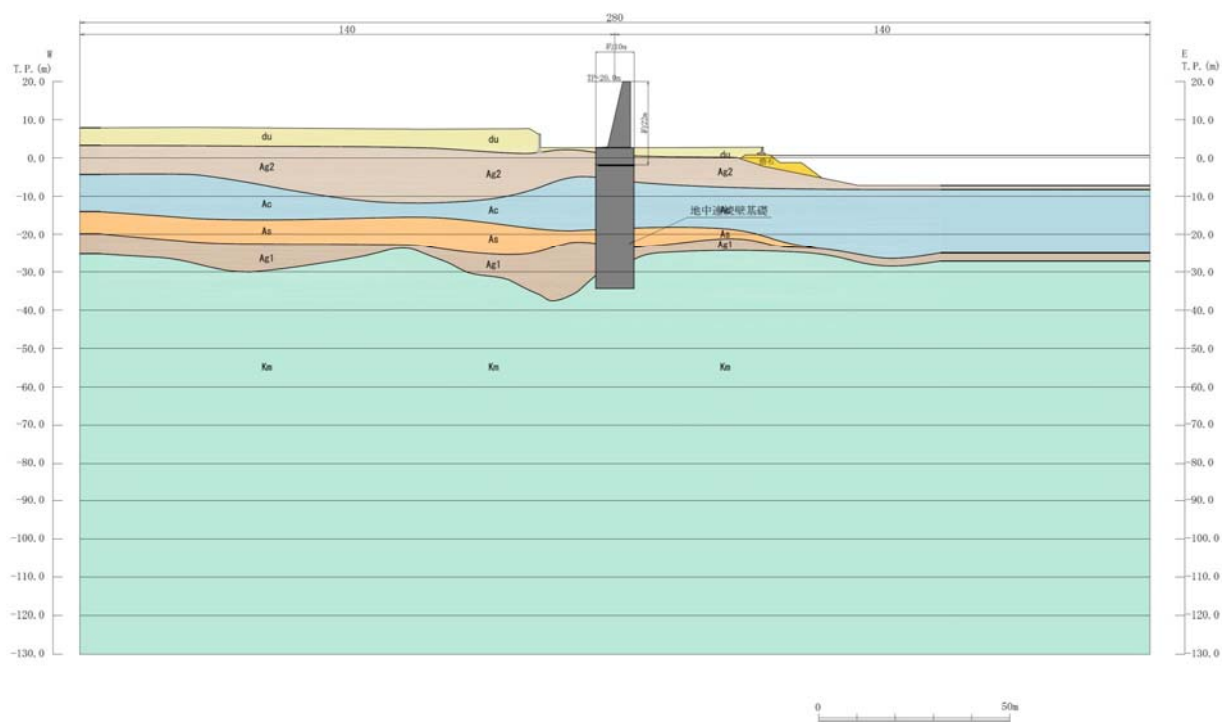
(4) 鉄筋コンクリート防潮壁 評価対象断面図 (④-④断面)
